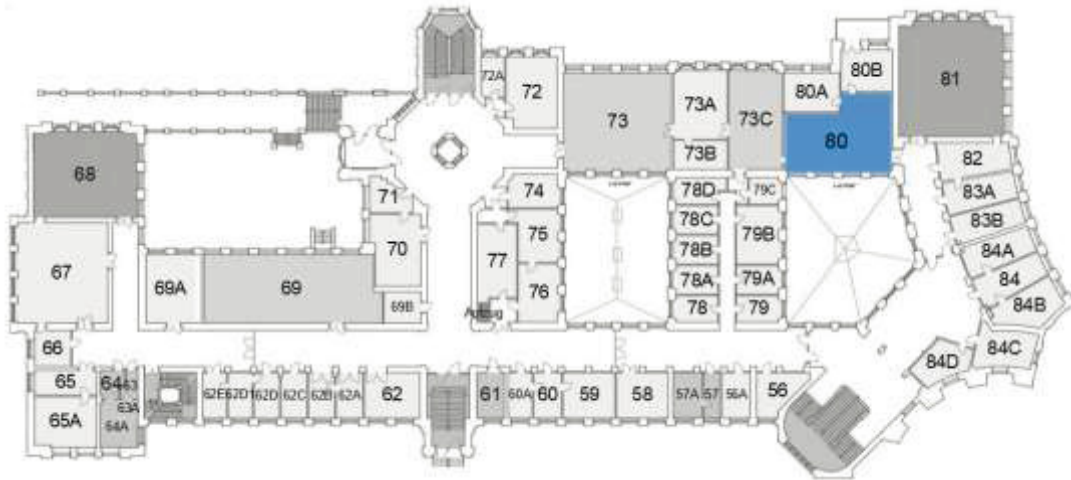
Grundriss des Beyer-Baus, Kennzeichnung Raum 80 (Quelle: Campus Navigator TU Dresden)
